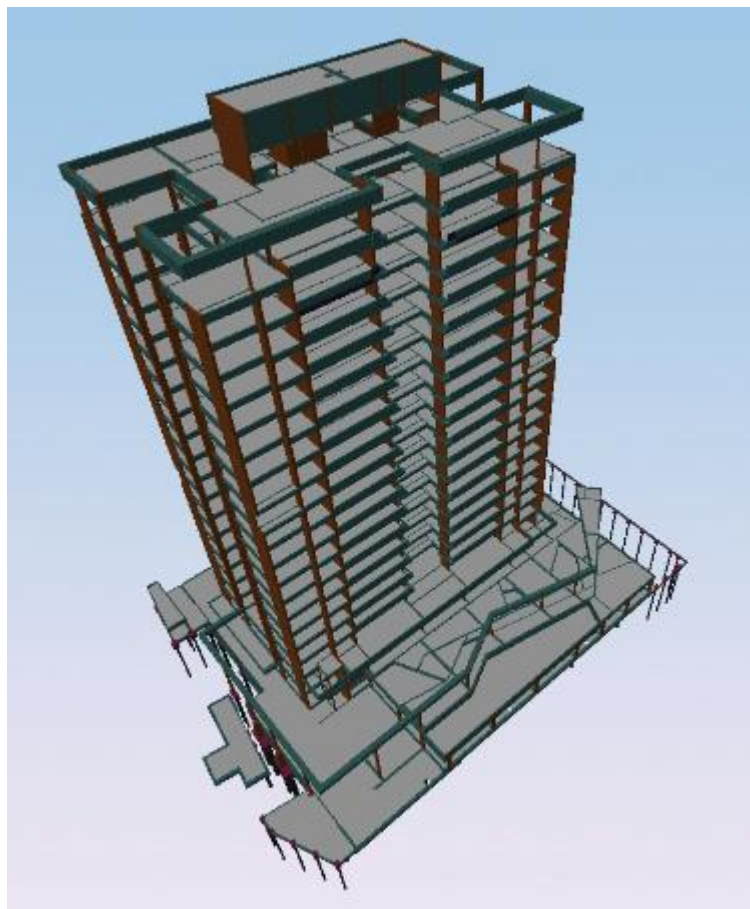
Imagem 3D da estrutura em concreto armado do edifício.
